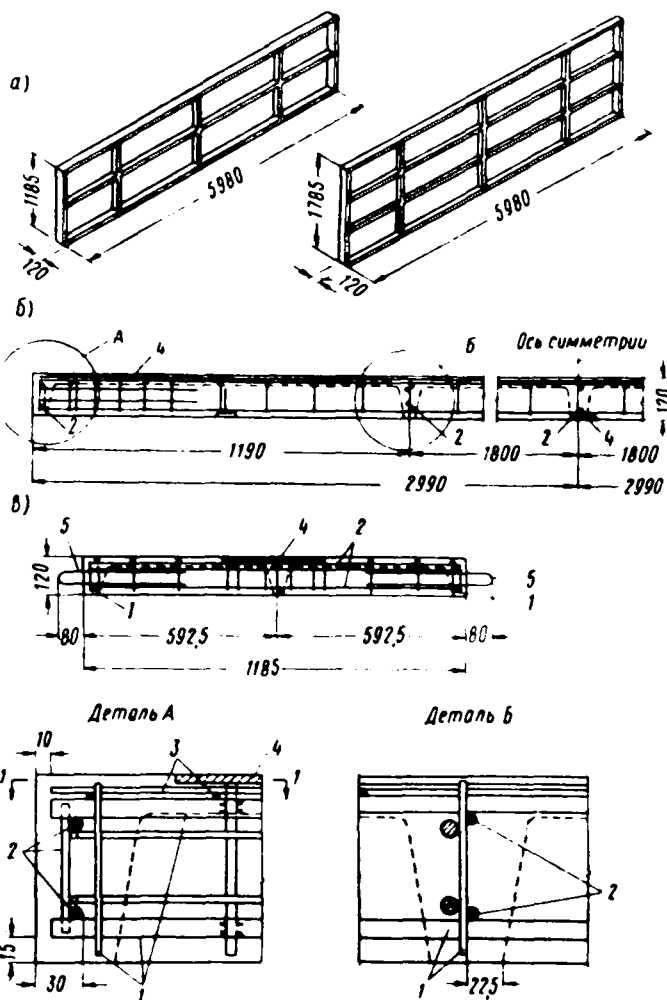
Типовые железобетонные стеновые панели длиной 6 м
